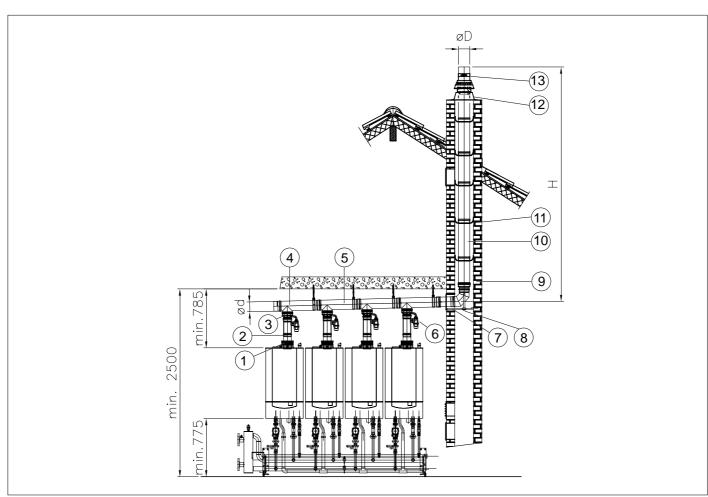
Überdruck Kaskadenabgassystem mit integrierter Rückschlagklappe für 2 bis 4 Remeha Quinta 45 / Quinta 65.
